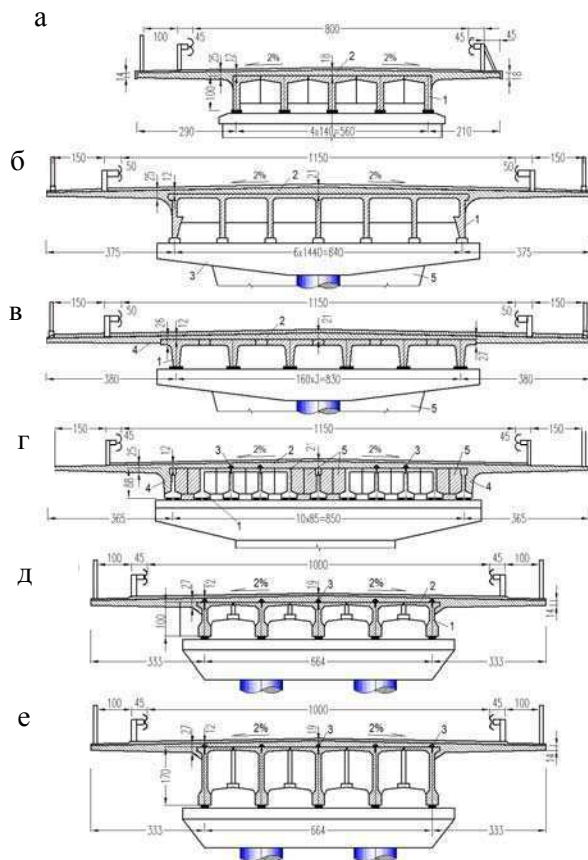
Схеми розширення прольотних будов різних типів монолітною залізобетонною накладною плитою: а, б – прольотні будови за ТП вип. 56 і 56Д; в, г, д, е – прольотні будови з попередньо напруженою будовою; 1 – існуючі прольотні будови; 2 – монолітна залізобетонна накладна плита з консолями; 3 – клеєстержневі анкери; 4 – обетонування фасадної поверхні крайньої балки; 5 – монолітні вставки підсилення балок
